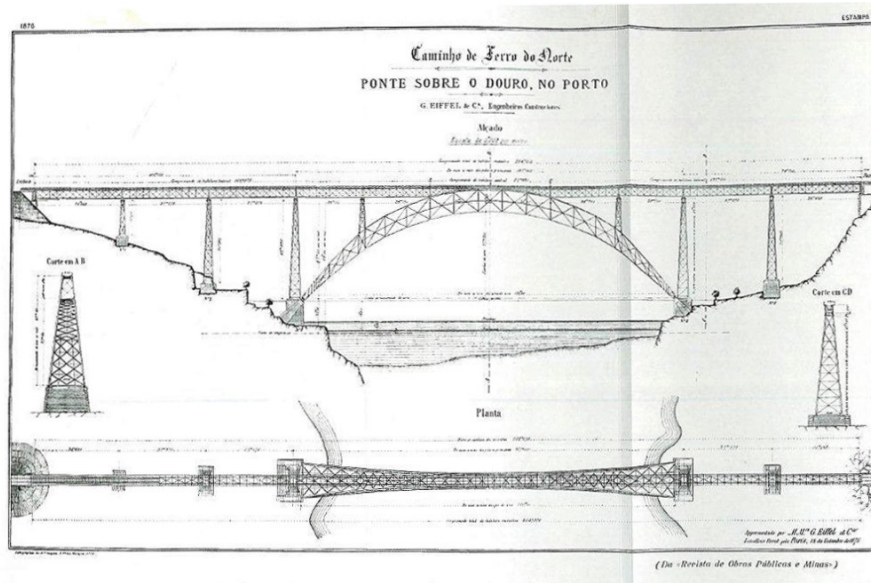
Ponte Maria Pia na entrada em serviço [62]
